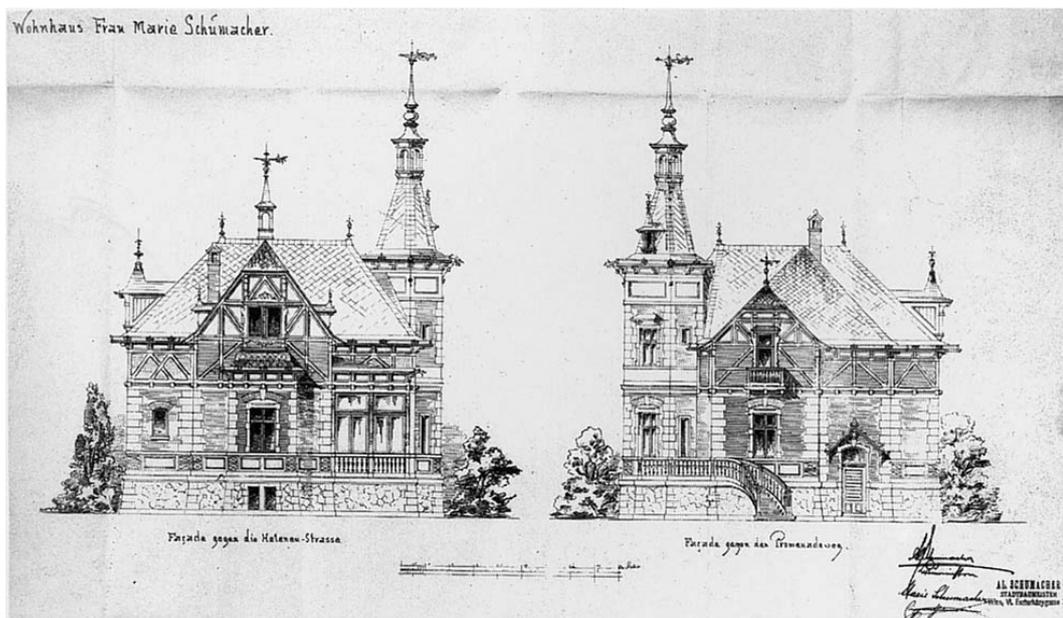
Villa Helenenstraße 45 in Baden. Aufriss. 1888. Einreichplan.
